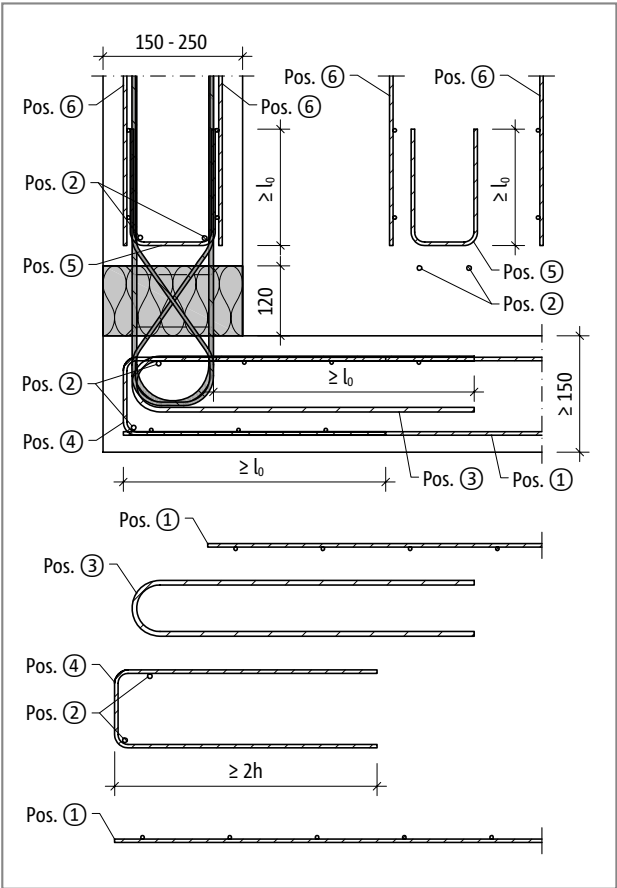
Schöck Isokorb® tipo ABXT - disposizione verticale: armatura in opera
